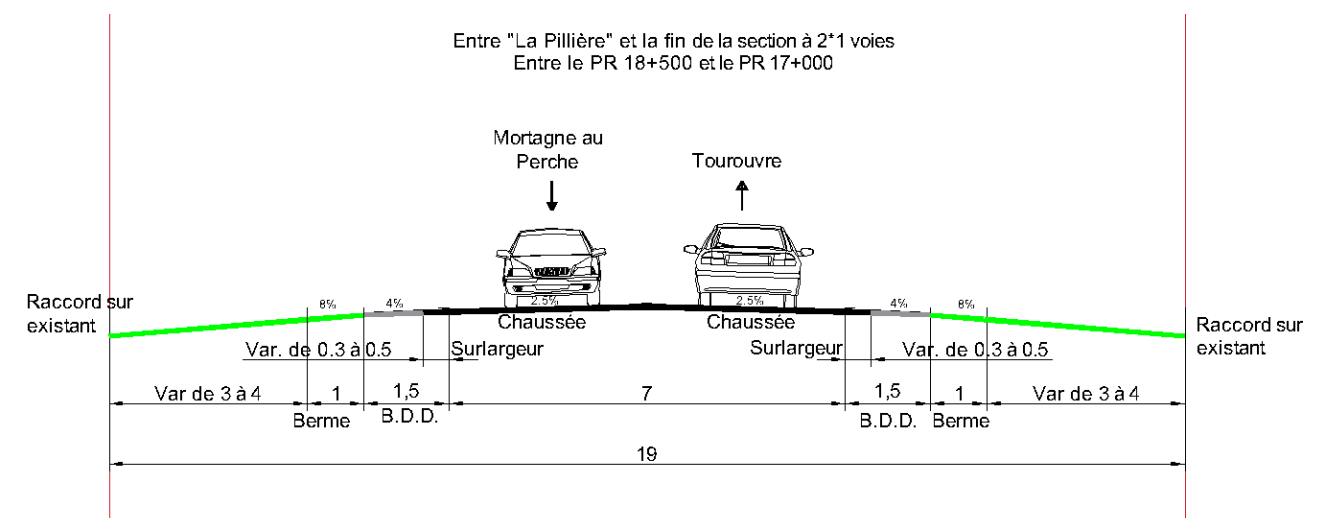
Profils en travers type - Entre " La Pilière " et la section à 2*2 voies (source: SEGIC)
